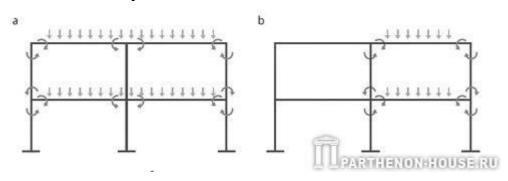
Вызванные перекрытиями изгибающие моменты в стенах: а - нагрузка на перекрытие симметричная; b - несимметричная нагрузка (влиянием ненагруженной части рамы пренебрегаем).
